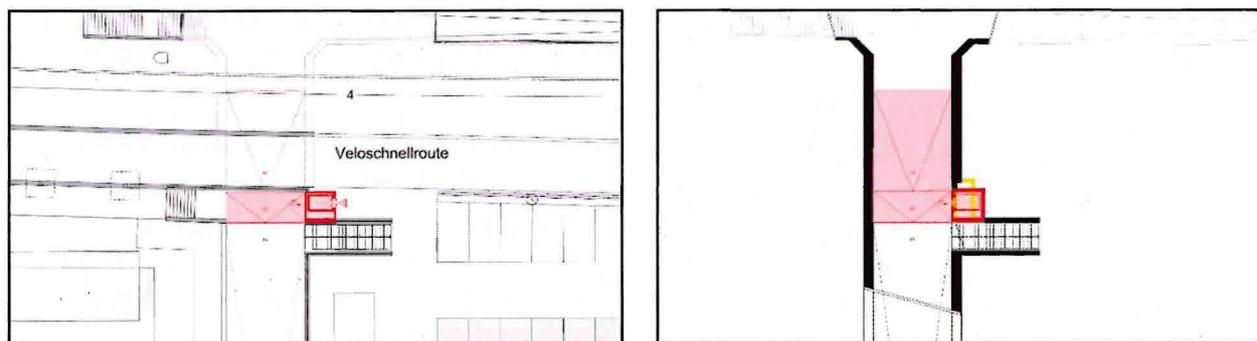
Grundrisse Lift Signumplatz (links Ebene Signumplatz, rechts Ebene Unterführung)
